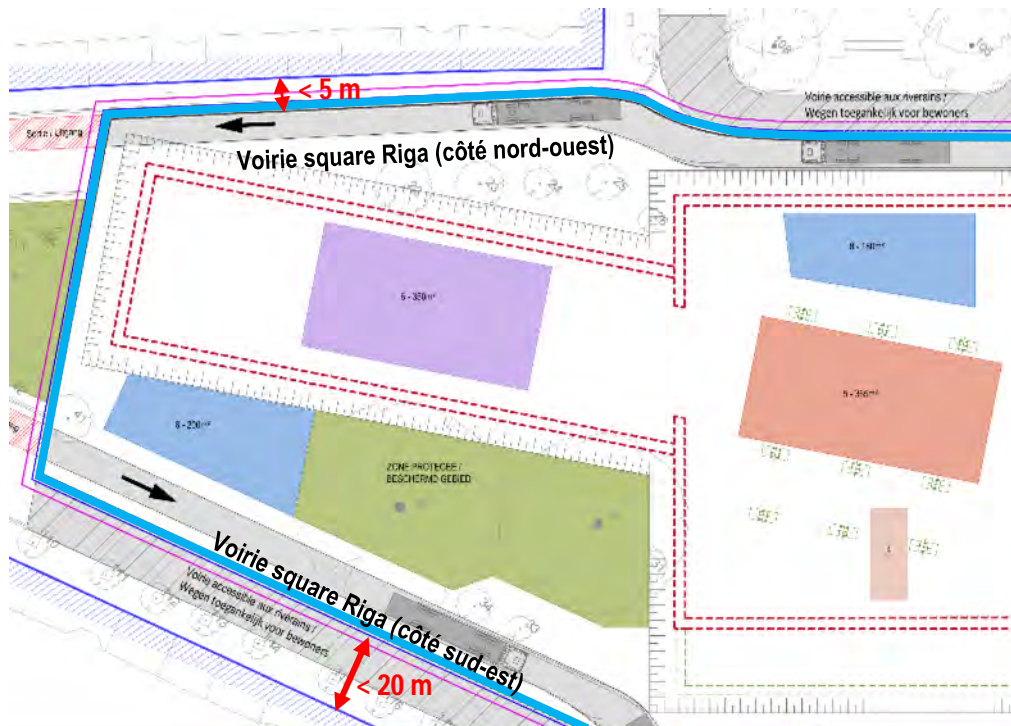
Distance entre la palissade et les façades les plus proches – Phases 1 à 5 (fond de plan de base : phase A) – Station Riga (ARIES, 2020 sur fond BMN, 2018)
